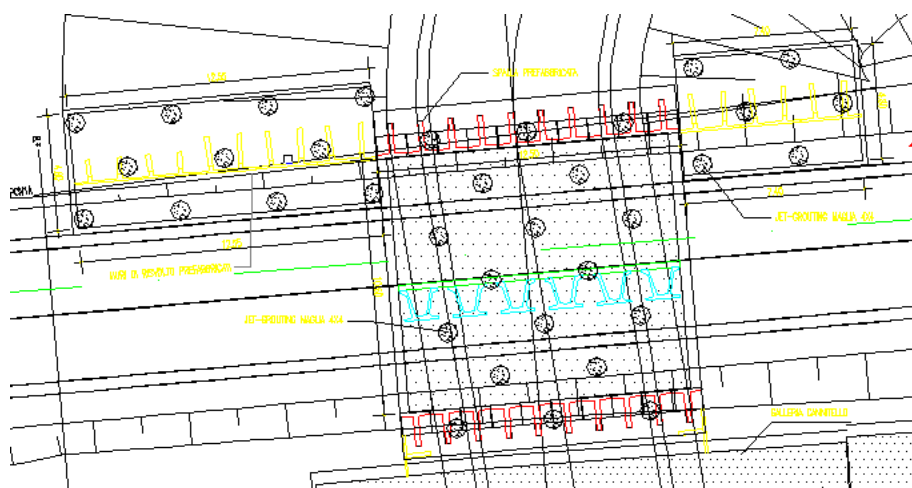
Disposizione planimetrica colonne di jet-grouting
